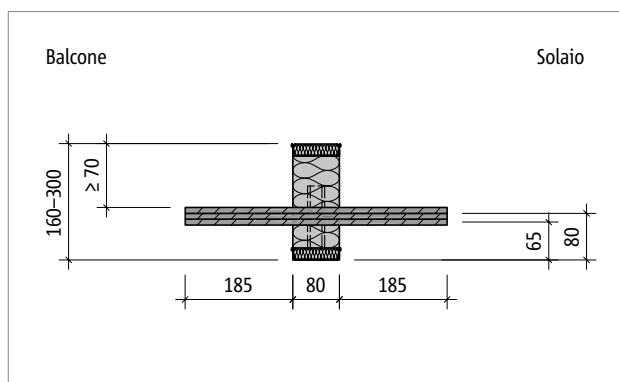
Schöck Isokorb® T tipo HP-VV1-NN1: sezione dell'elemento
